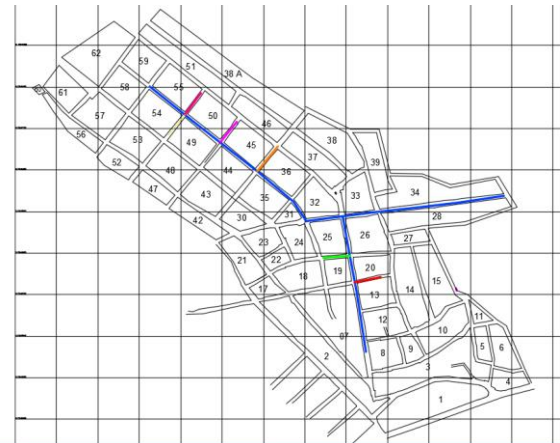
Planta inicial do loteamento. Fonte: Autoral
